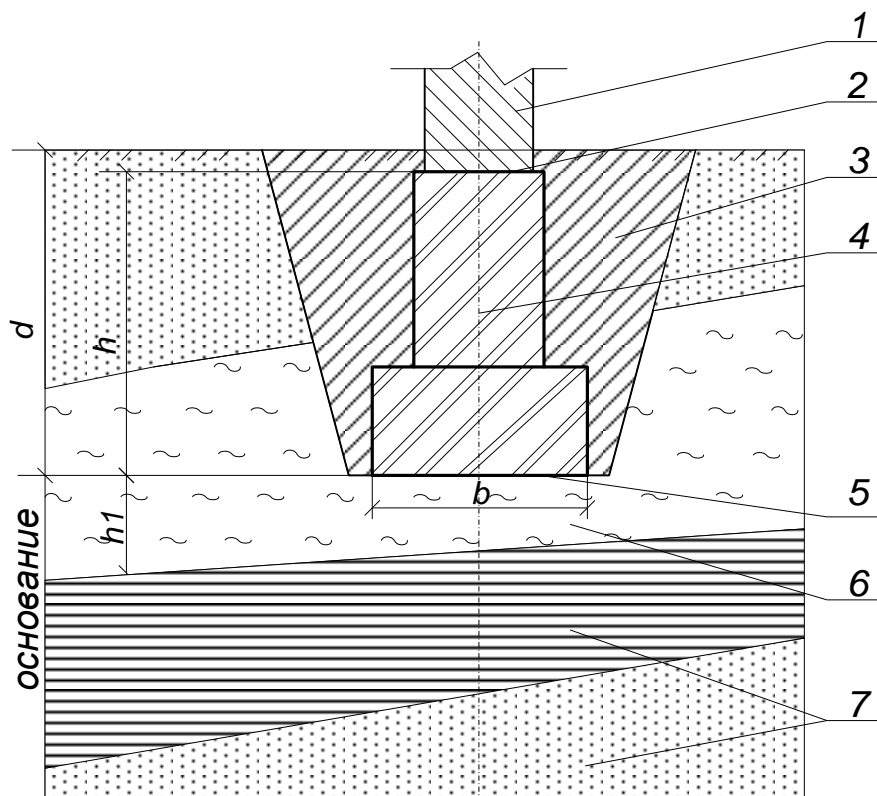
Схема фундамента: 1 - конструкция надземного сооружения; 2 - обрез фундамента; 3 - грунт обратной засыпки котлована; 4 - фундамент; 5 - подошва; 6 - несущий слой основания; 7 - грунт.
